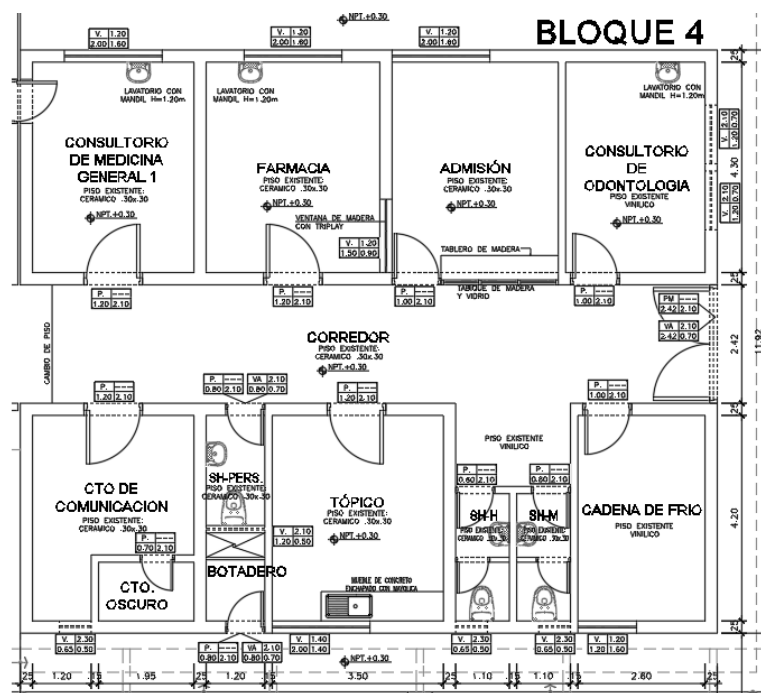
PLANO DE PLANTA DE BLOQUE 4 – PAIMAS I-4
